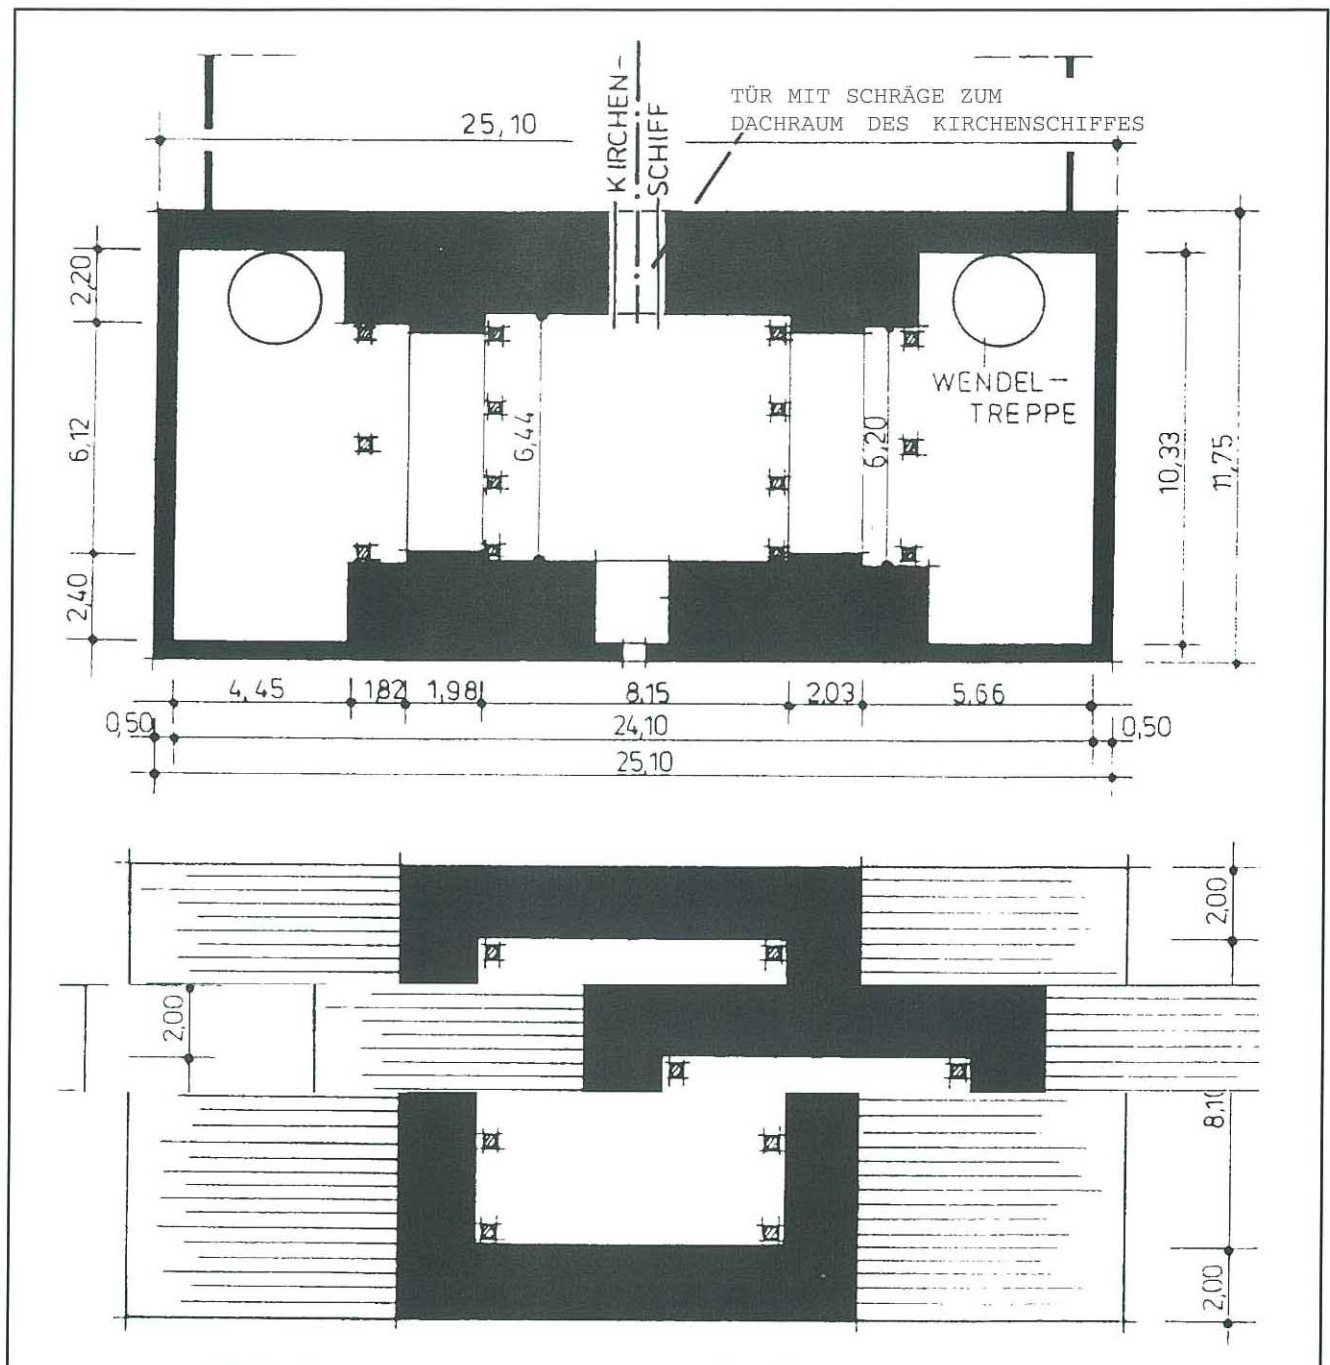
Grundrisse verschiedener Ebenen des Kirchturms; Turmebenen siehe Abb. 1
